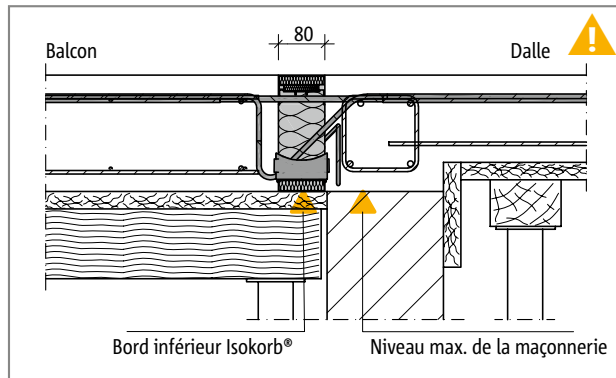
Schöck Isokorb® T Type K-E, K-T : Balcon en béton coulé sur place avec plancher surélevé sur mur en maçonnerie
